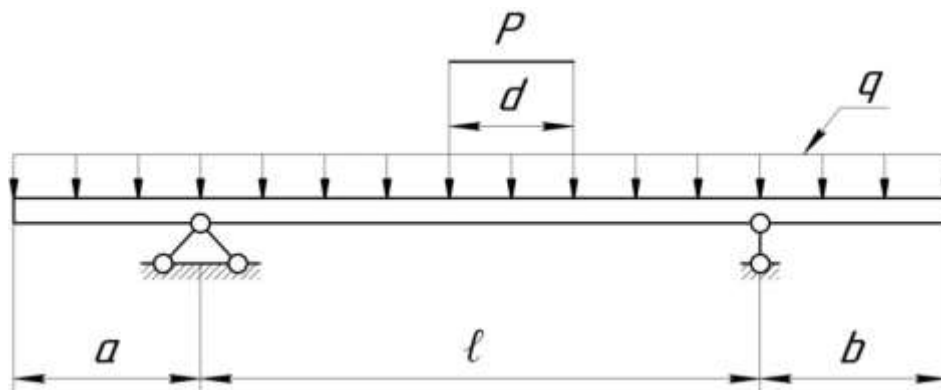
Расчетная схема для подбора поперечного сечения сварной балки
